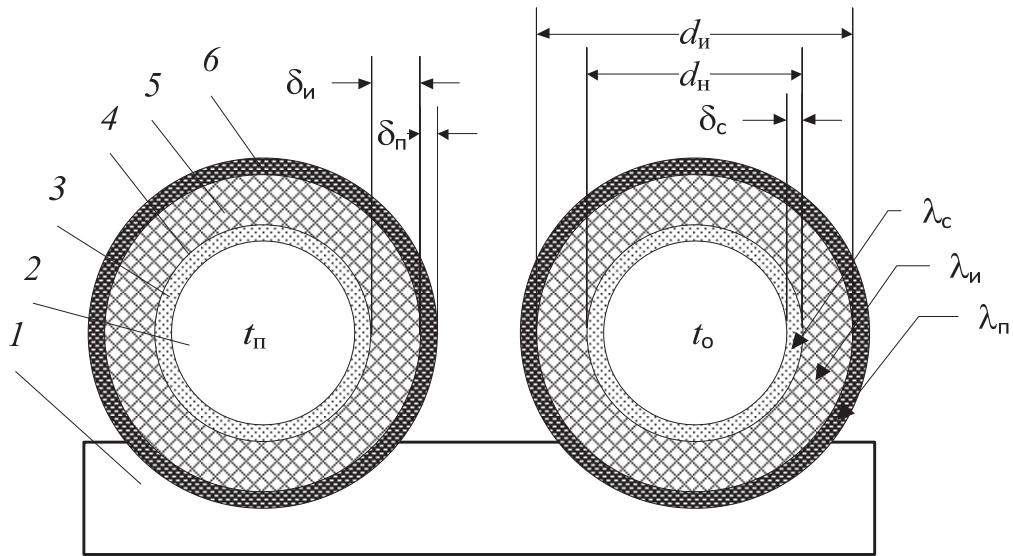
Схема двухтрубной теплоизолированной конструкции теплопровода надземной прокладки:
